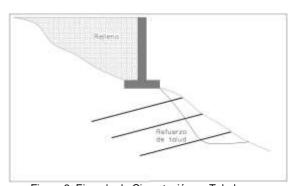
Ejemplo de Cimentación en Talud Aplicando Refuerzos
